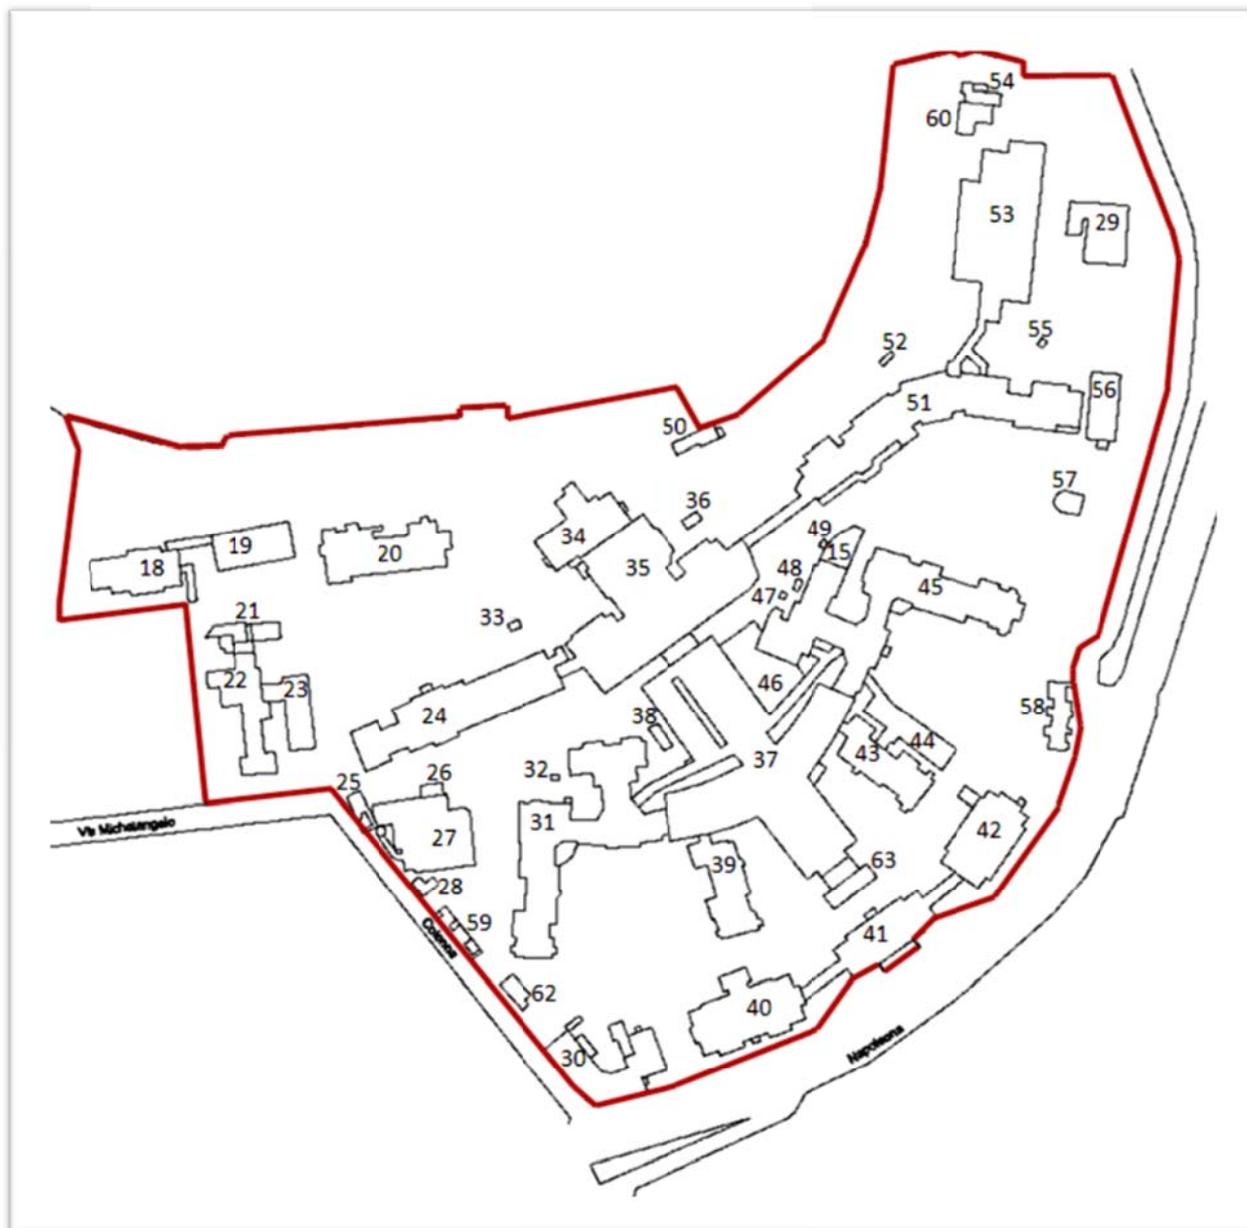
Elaborato planimetrico del comparto Sant'Anna
